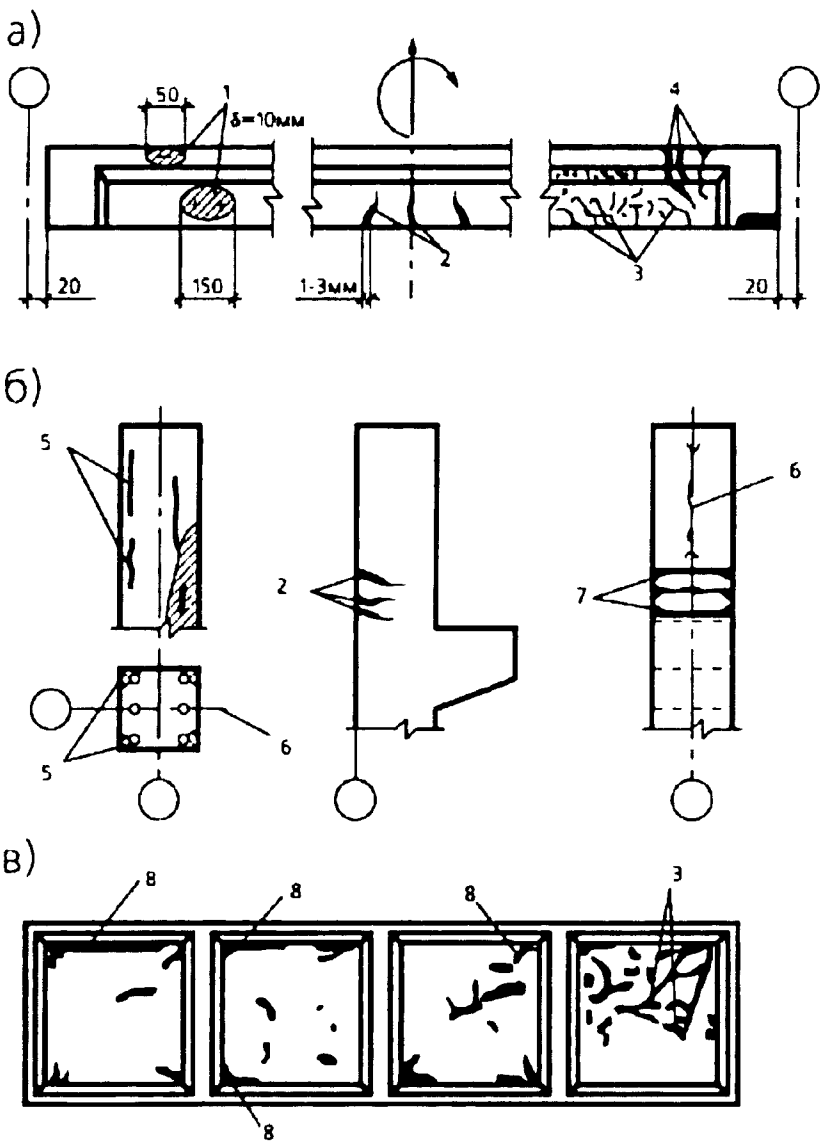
Примеры образования трещин и повреждений от огневого воздействия в элементах железобетонных конструкций:
